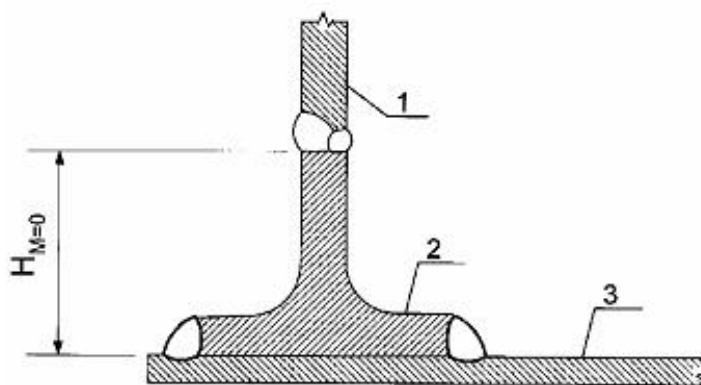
Схема исполнения соединения стенки и днища резервуара
